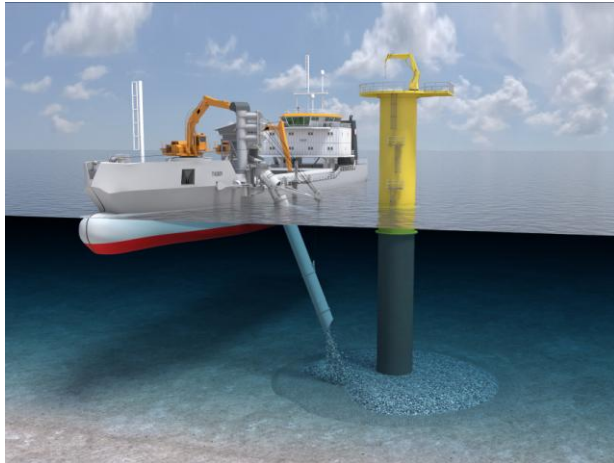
Typy základových konstrukcí offshore VtE [13]
